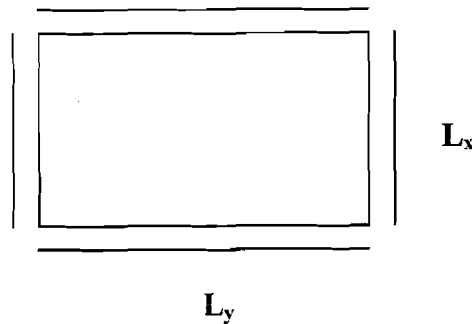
a Denah Rencana Pelat Lantai 1
